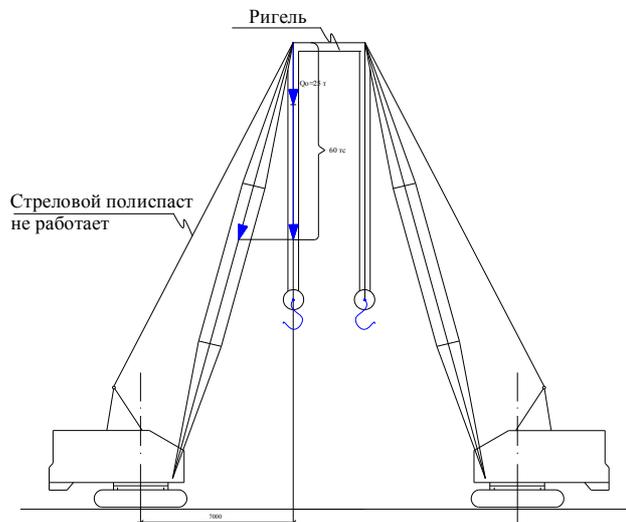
Схема монтажа спаренных кранов со стрелами, соединенными ригелем.
